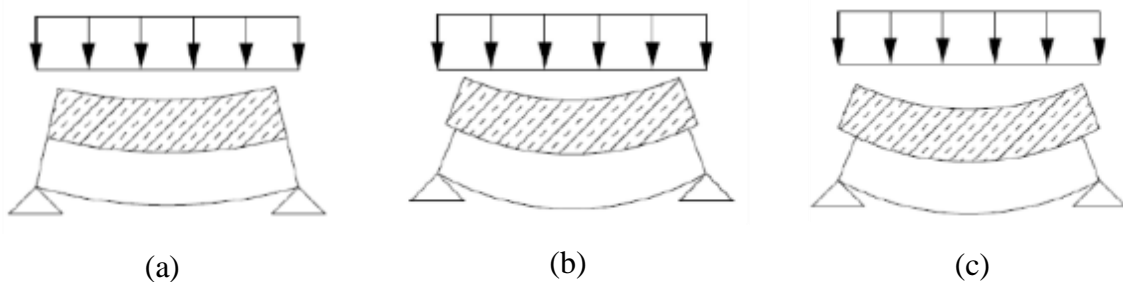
Comportement des planchers mixtes bois-béton : (a) connecteurs parfaitement rigides ; (b) connecteurs déformables ; (c) aucune connexion
